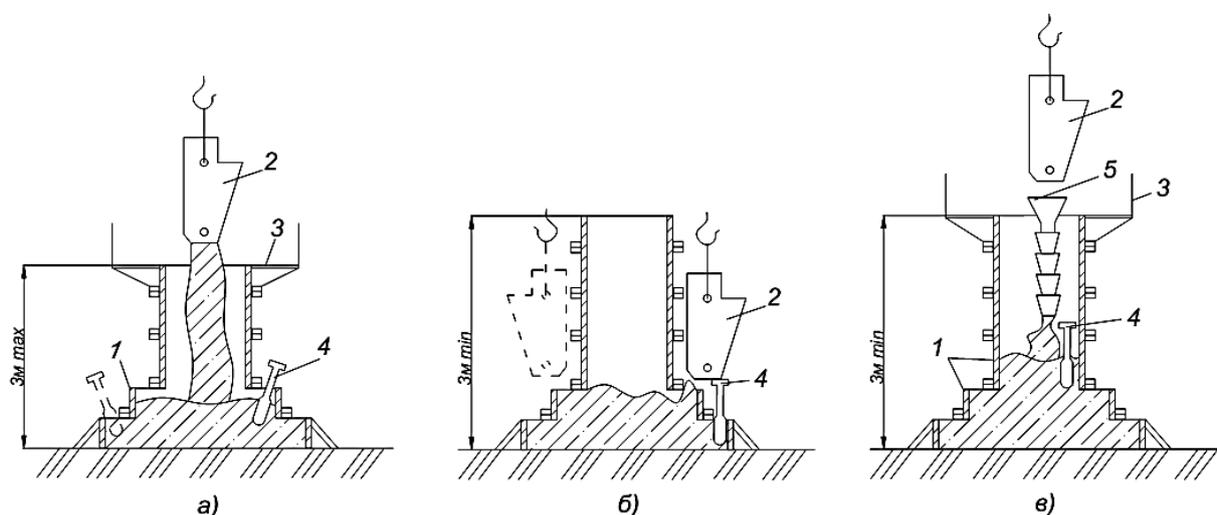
Схемы бетонирования ступенчатых фундаментов:
